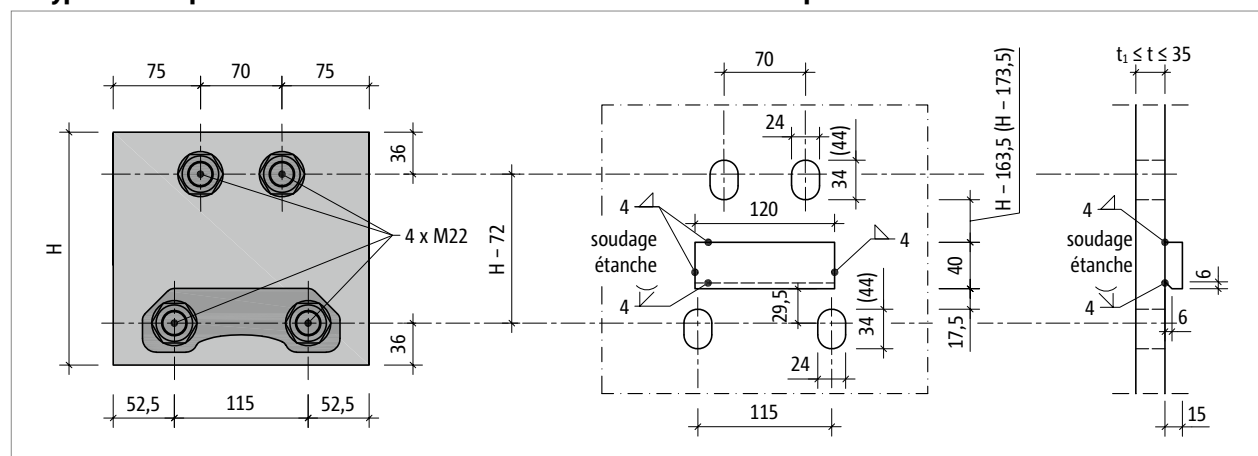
Schöck Isokorb® XT type SK-MM2 : construction de la platine frontale de raccordement
